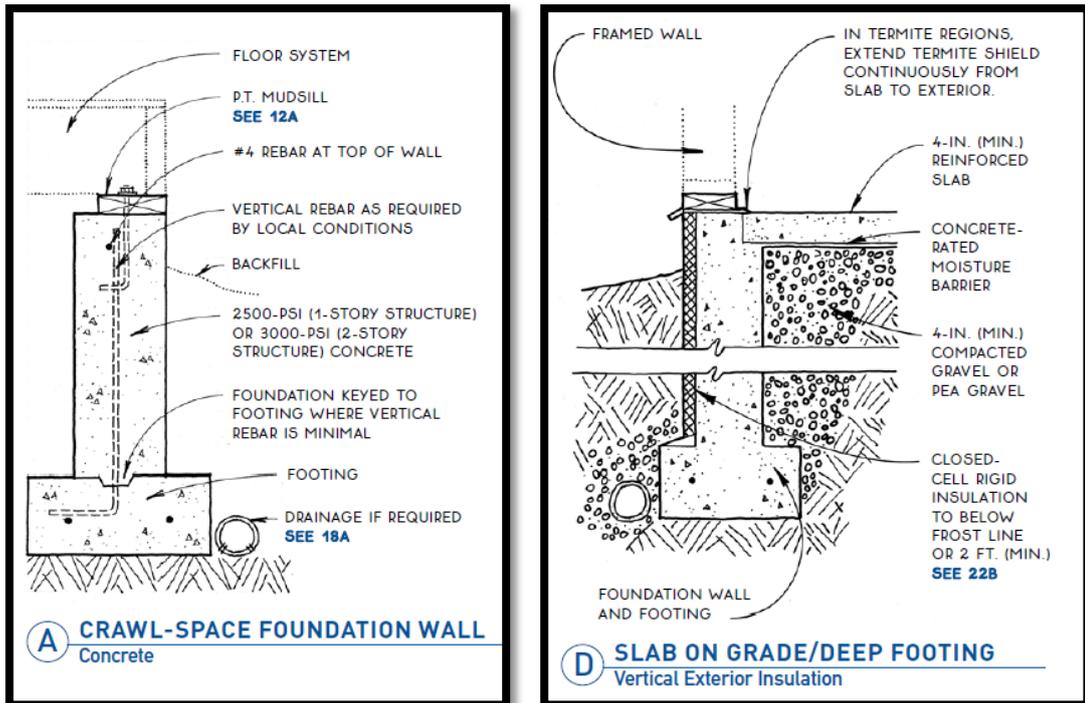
Detalles de Fundaciones. Fuente: Fuente: Frame Construction.
